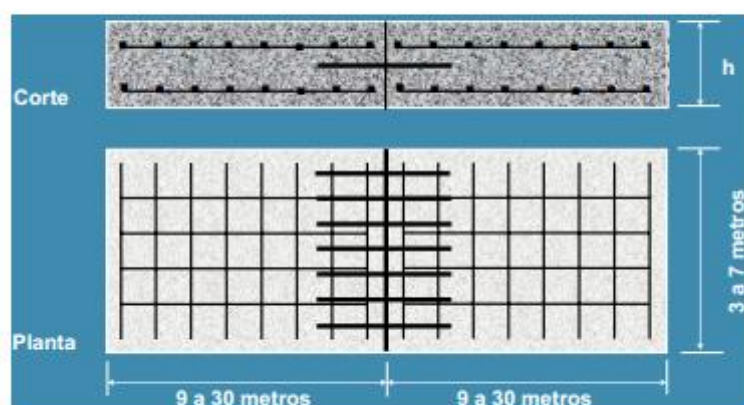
Pavimento de Concreto Estruturalmente Armado
